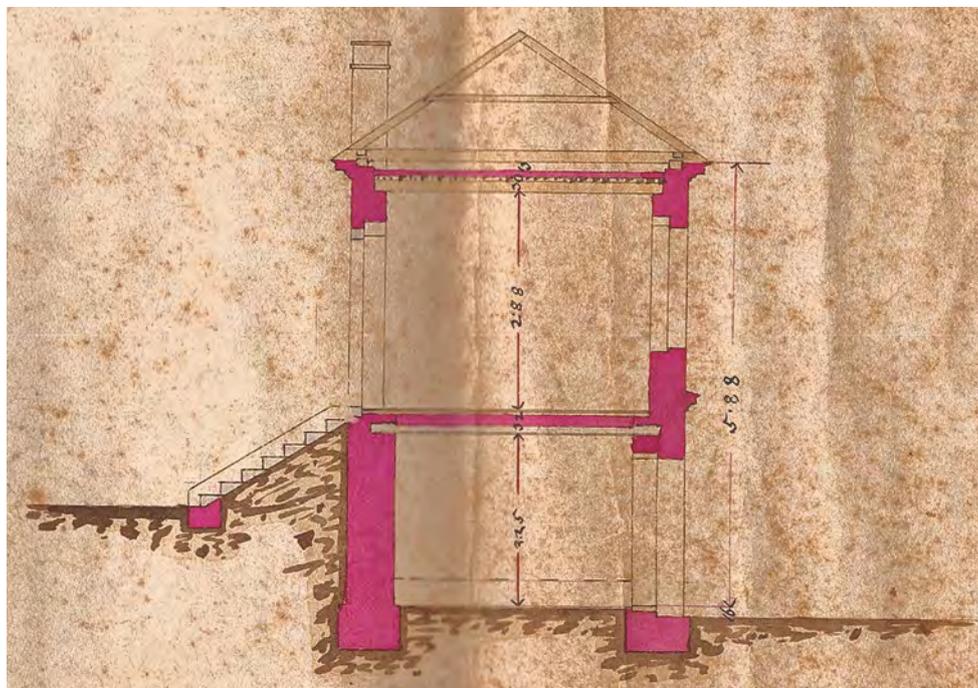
Schnitt u-v durch das Leichenhaus, Plan vom Umbau, Februar 1882
